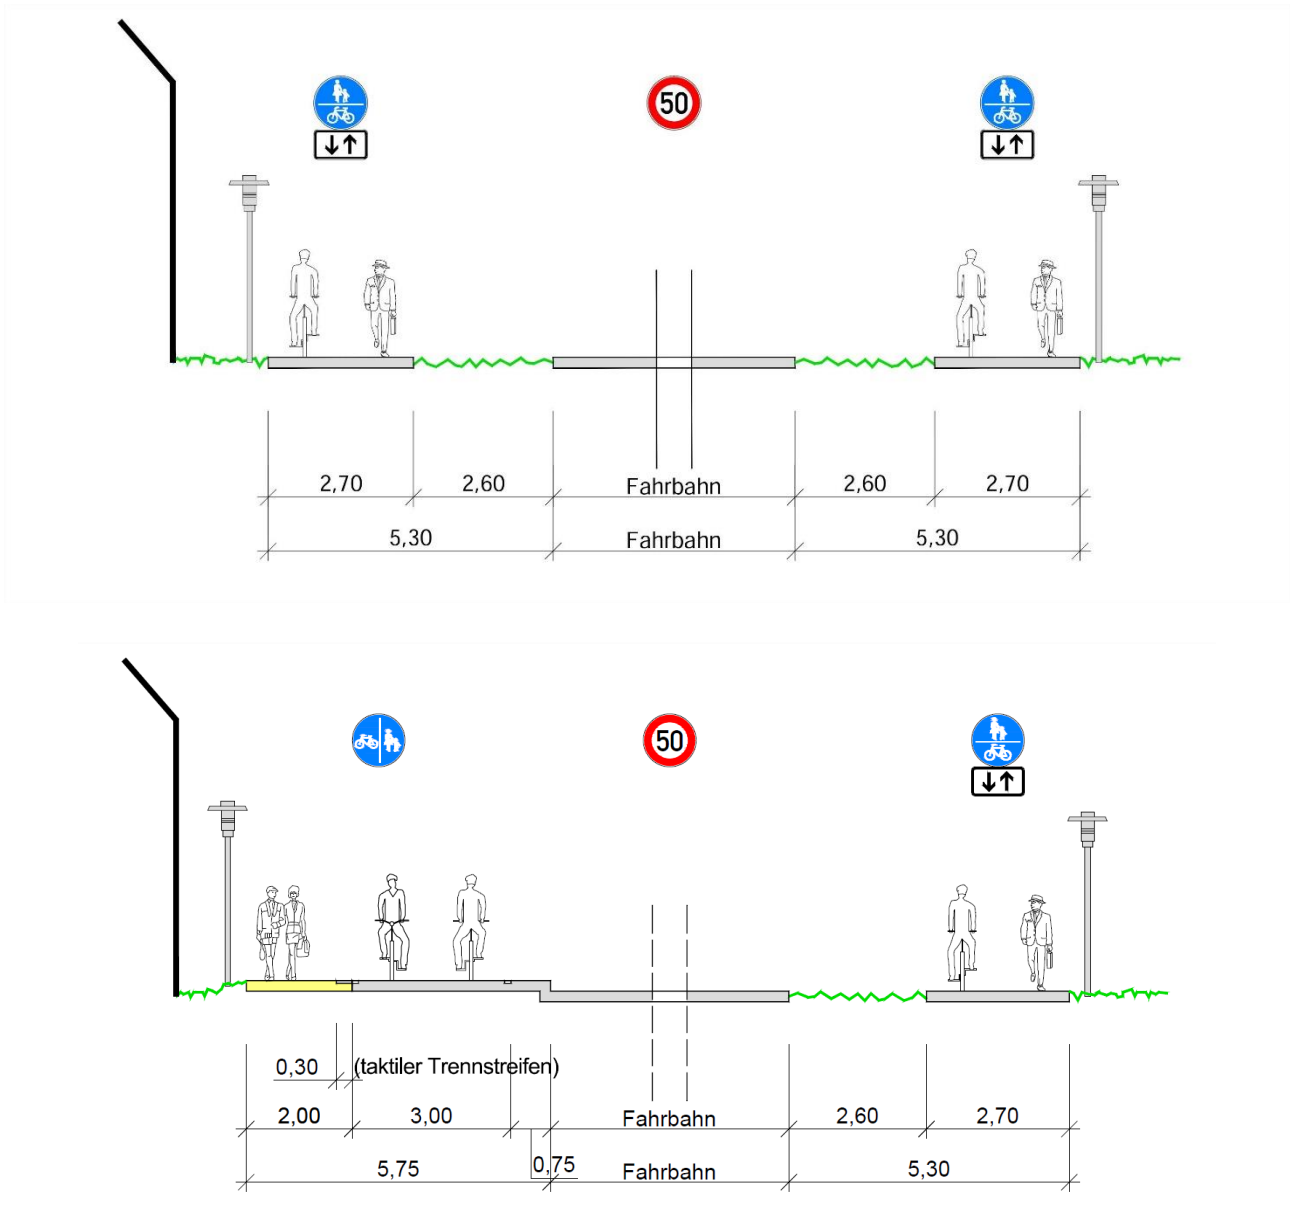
Schleißheimer Straße (Beginn Parallelschließung bis Zeppelinstraße) – Bestand (oben) und Planung (unten)
